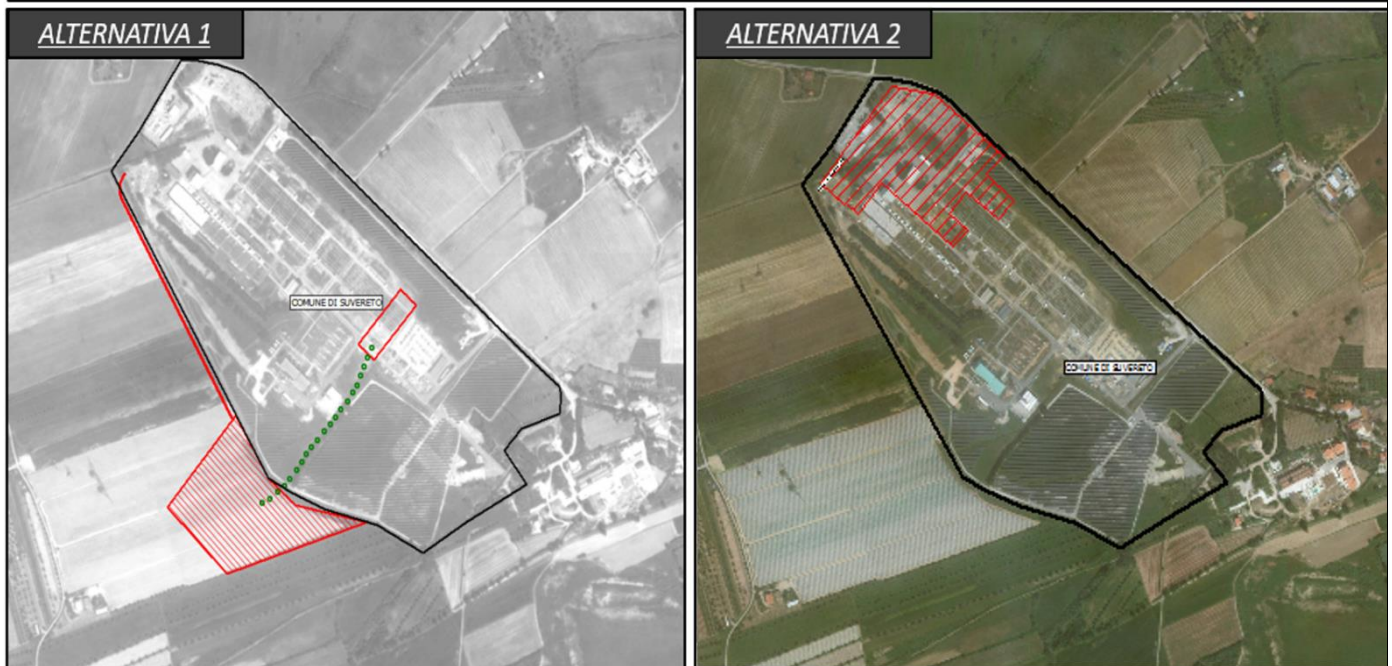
Intervento F - Stazione di conversione di Suvereto – alternative di progetto
